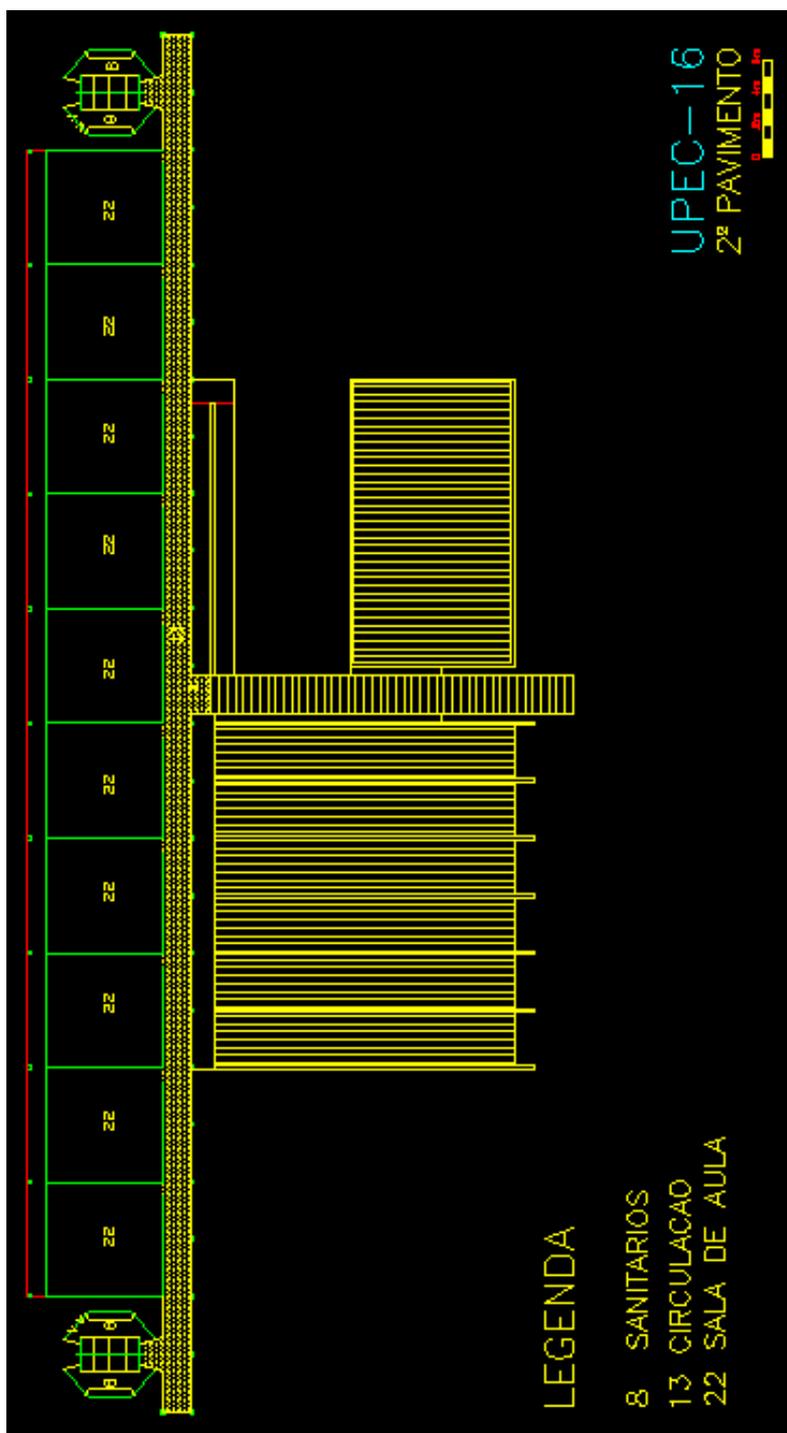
UPEC-16 / PLANTA 2º NÍVEL
